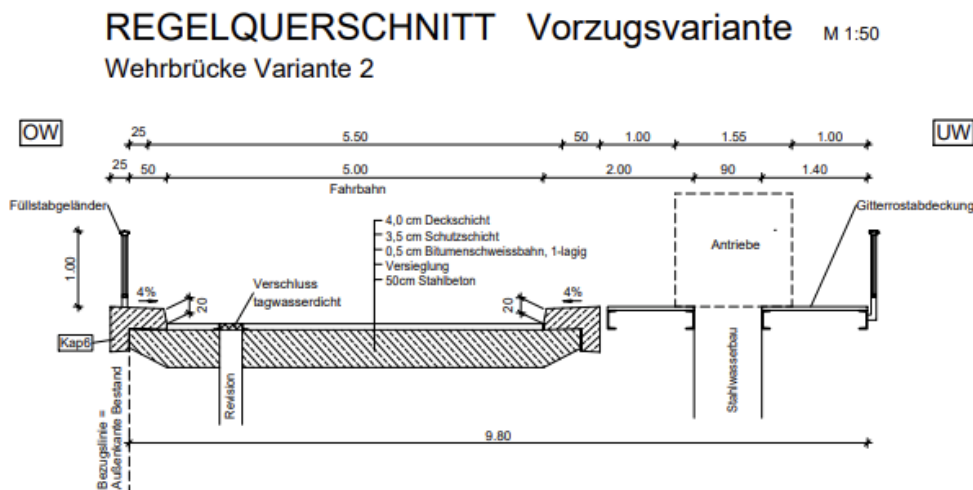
Wehrbrücke Regelquerschnitt 2
